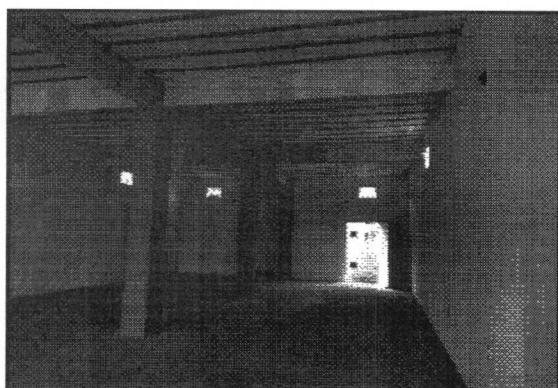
Vista da Galpão, com aos pilares de concreto armado no centro.
